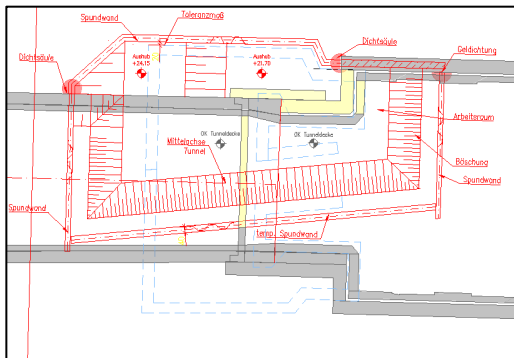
Ausschnitt Plan GuD Zi\_BG-VP 001 Grundriss (unmaßstäblich)
